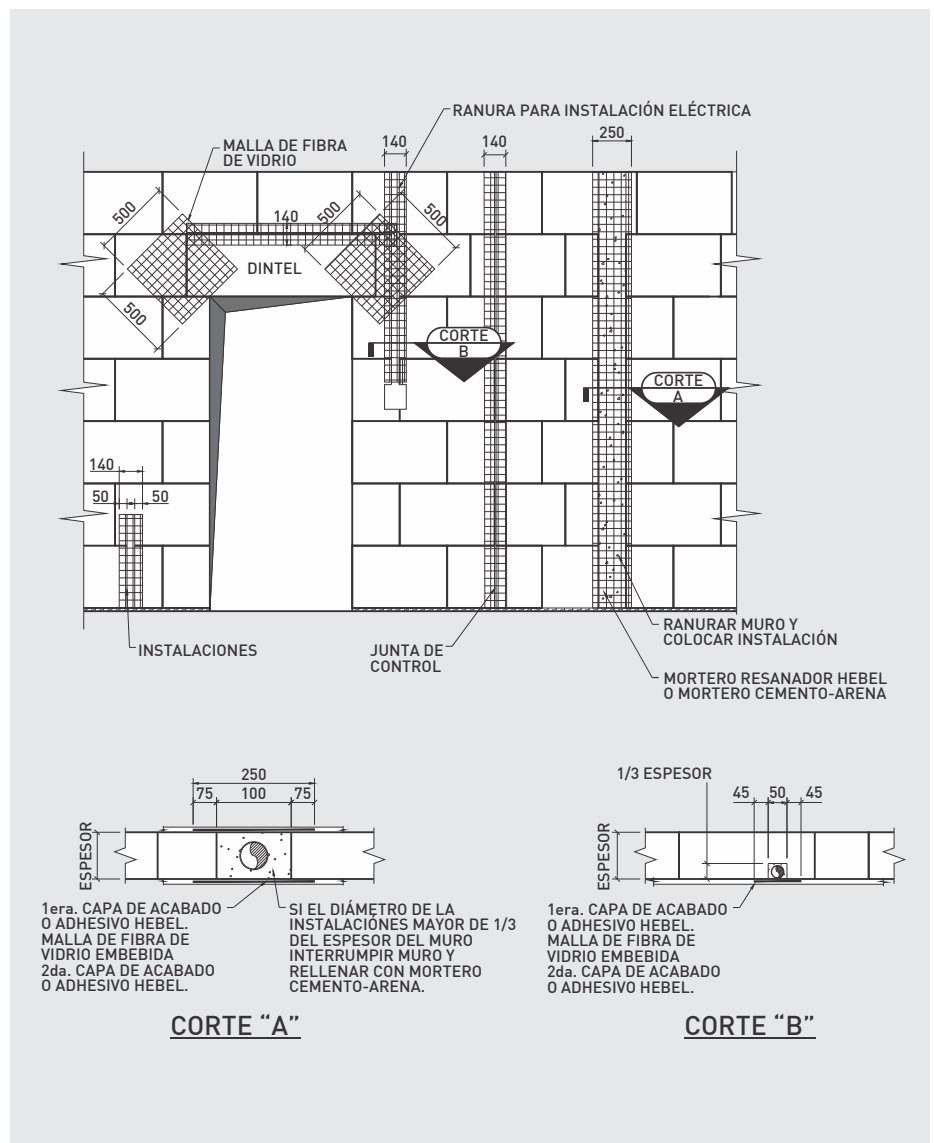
Detalle de instalaciones y colocación de malla de fibra de vidrio.
